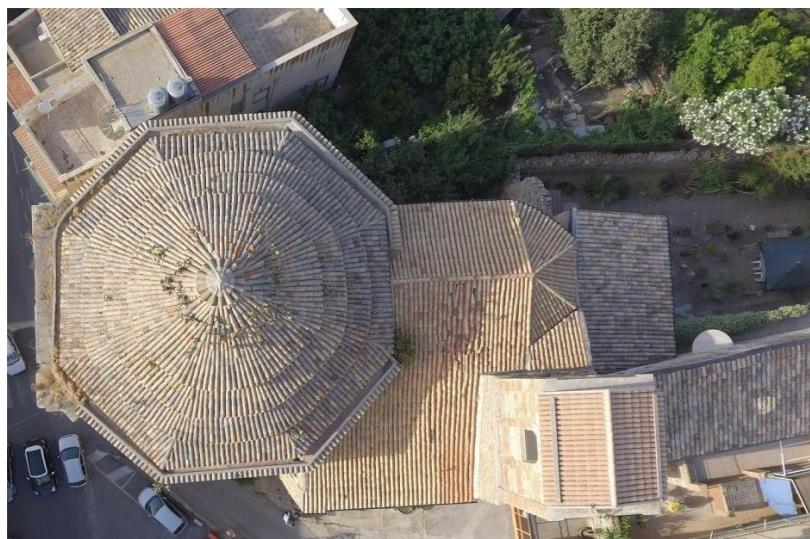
La chiesa del convento dei Carmelitani vista dall'alto. Foto da ADORNETTO, 2021.
